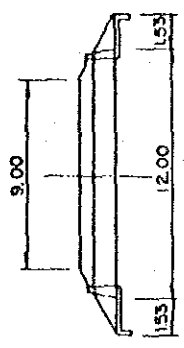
Alcantarilla Metálica Corrugada Alcantarilla Cajón y Puentes.
